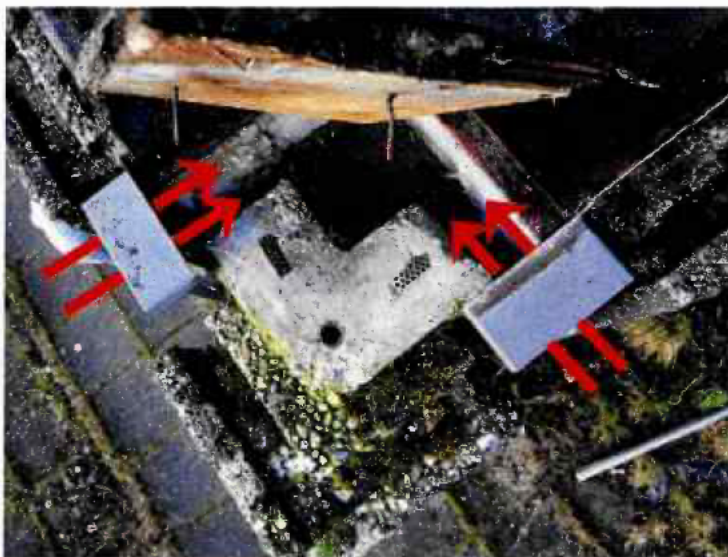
Beschikbare ruimte aan de hoek van een van de lage blokdelen.
